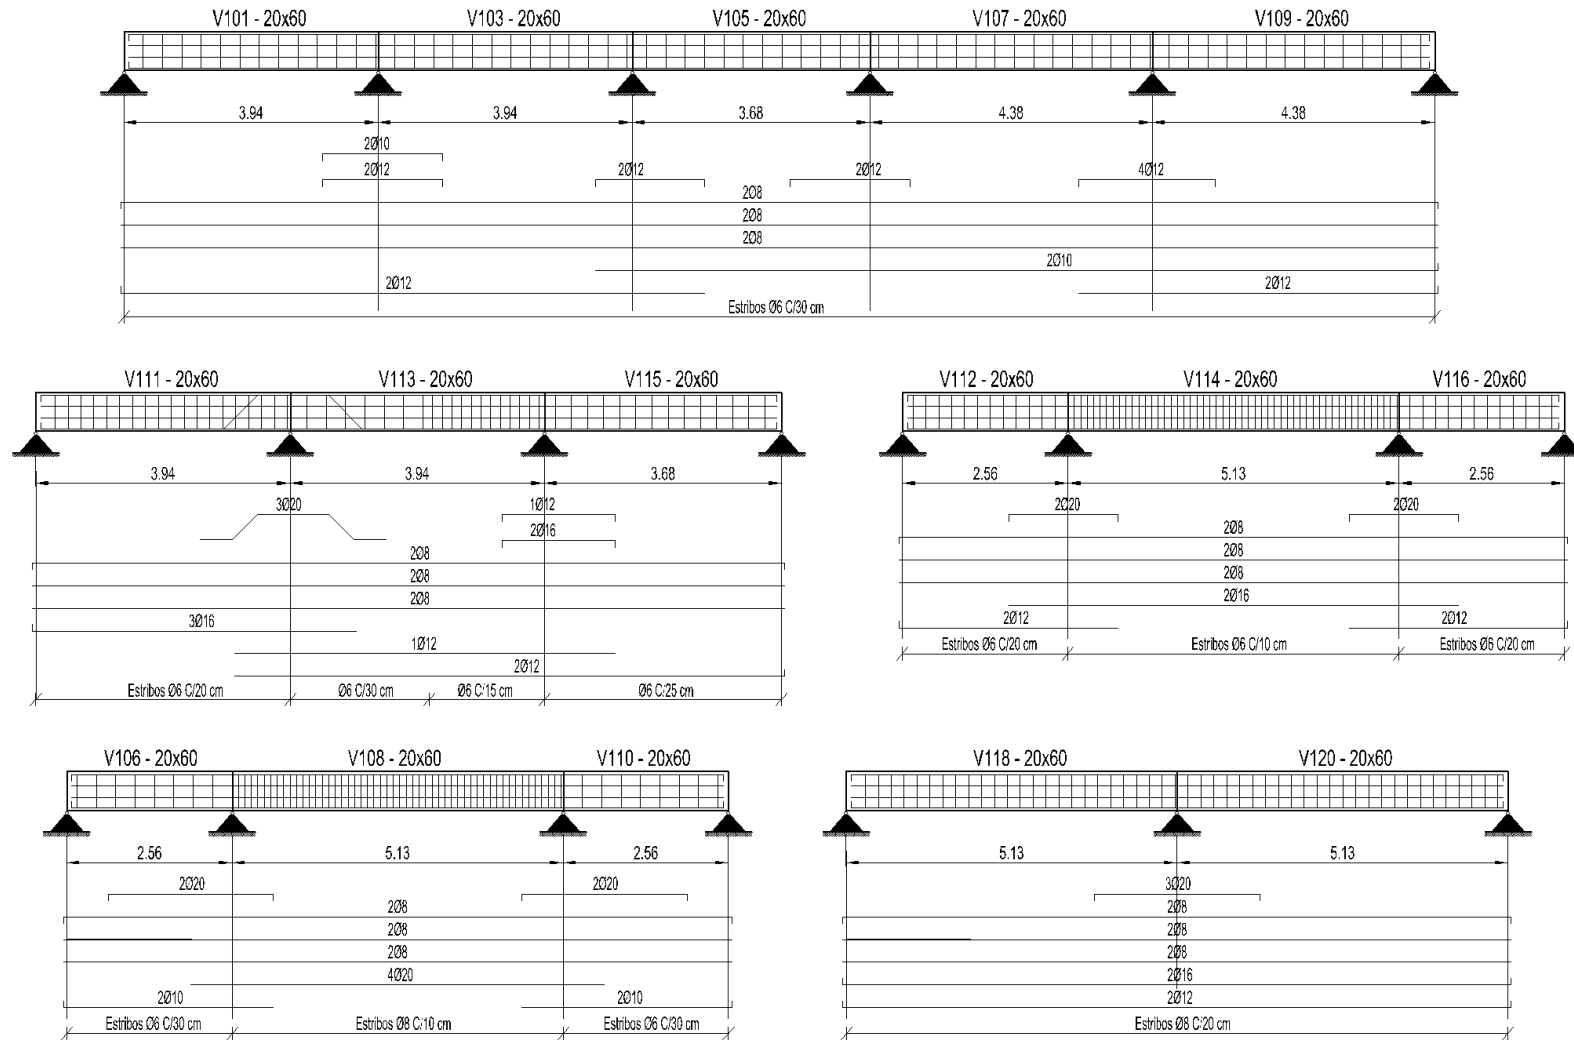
Armado de vigas sobre P.B. y 1er Piso.
